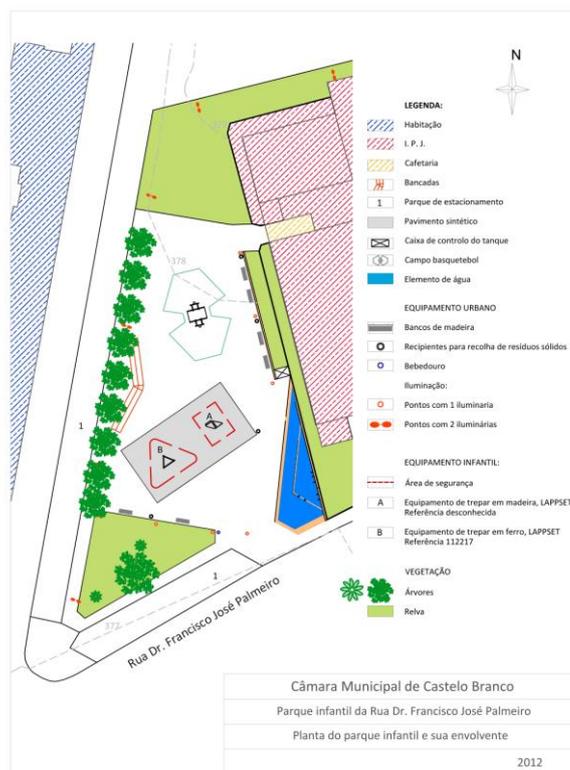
Planta do parque infantil da Rua Dr. Francisco Palmeiro. (Planta elaborada pela autora)
